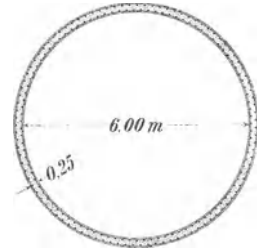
Eisenbewehrter Stampfbeton. (Zulässige Beanspruchung 30 kg/qcm.)
